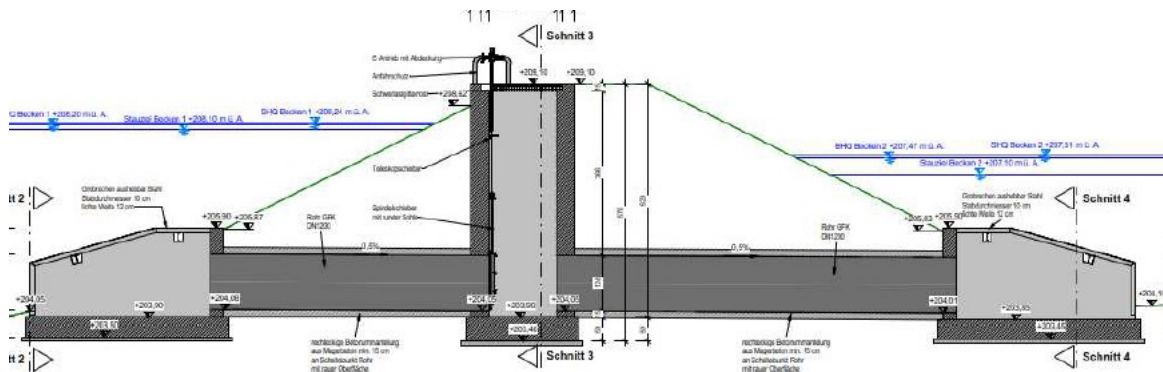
Schnitt durch des Trennbauwerk ([13], Kap.7.5.3, Abb.44)
